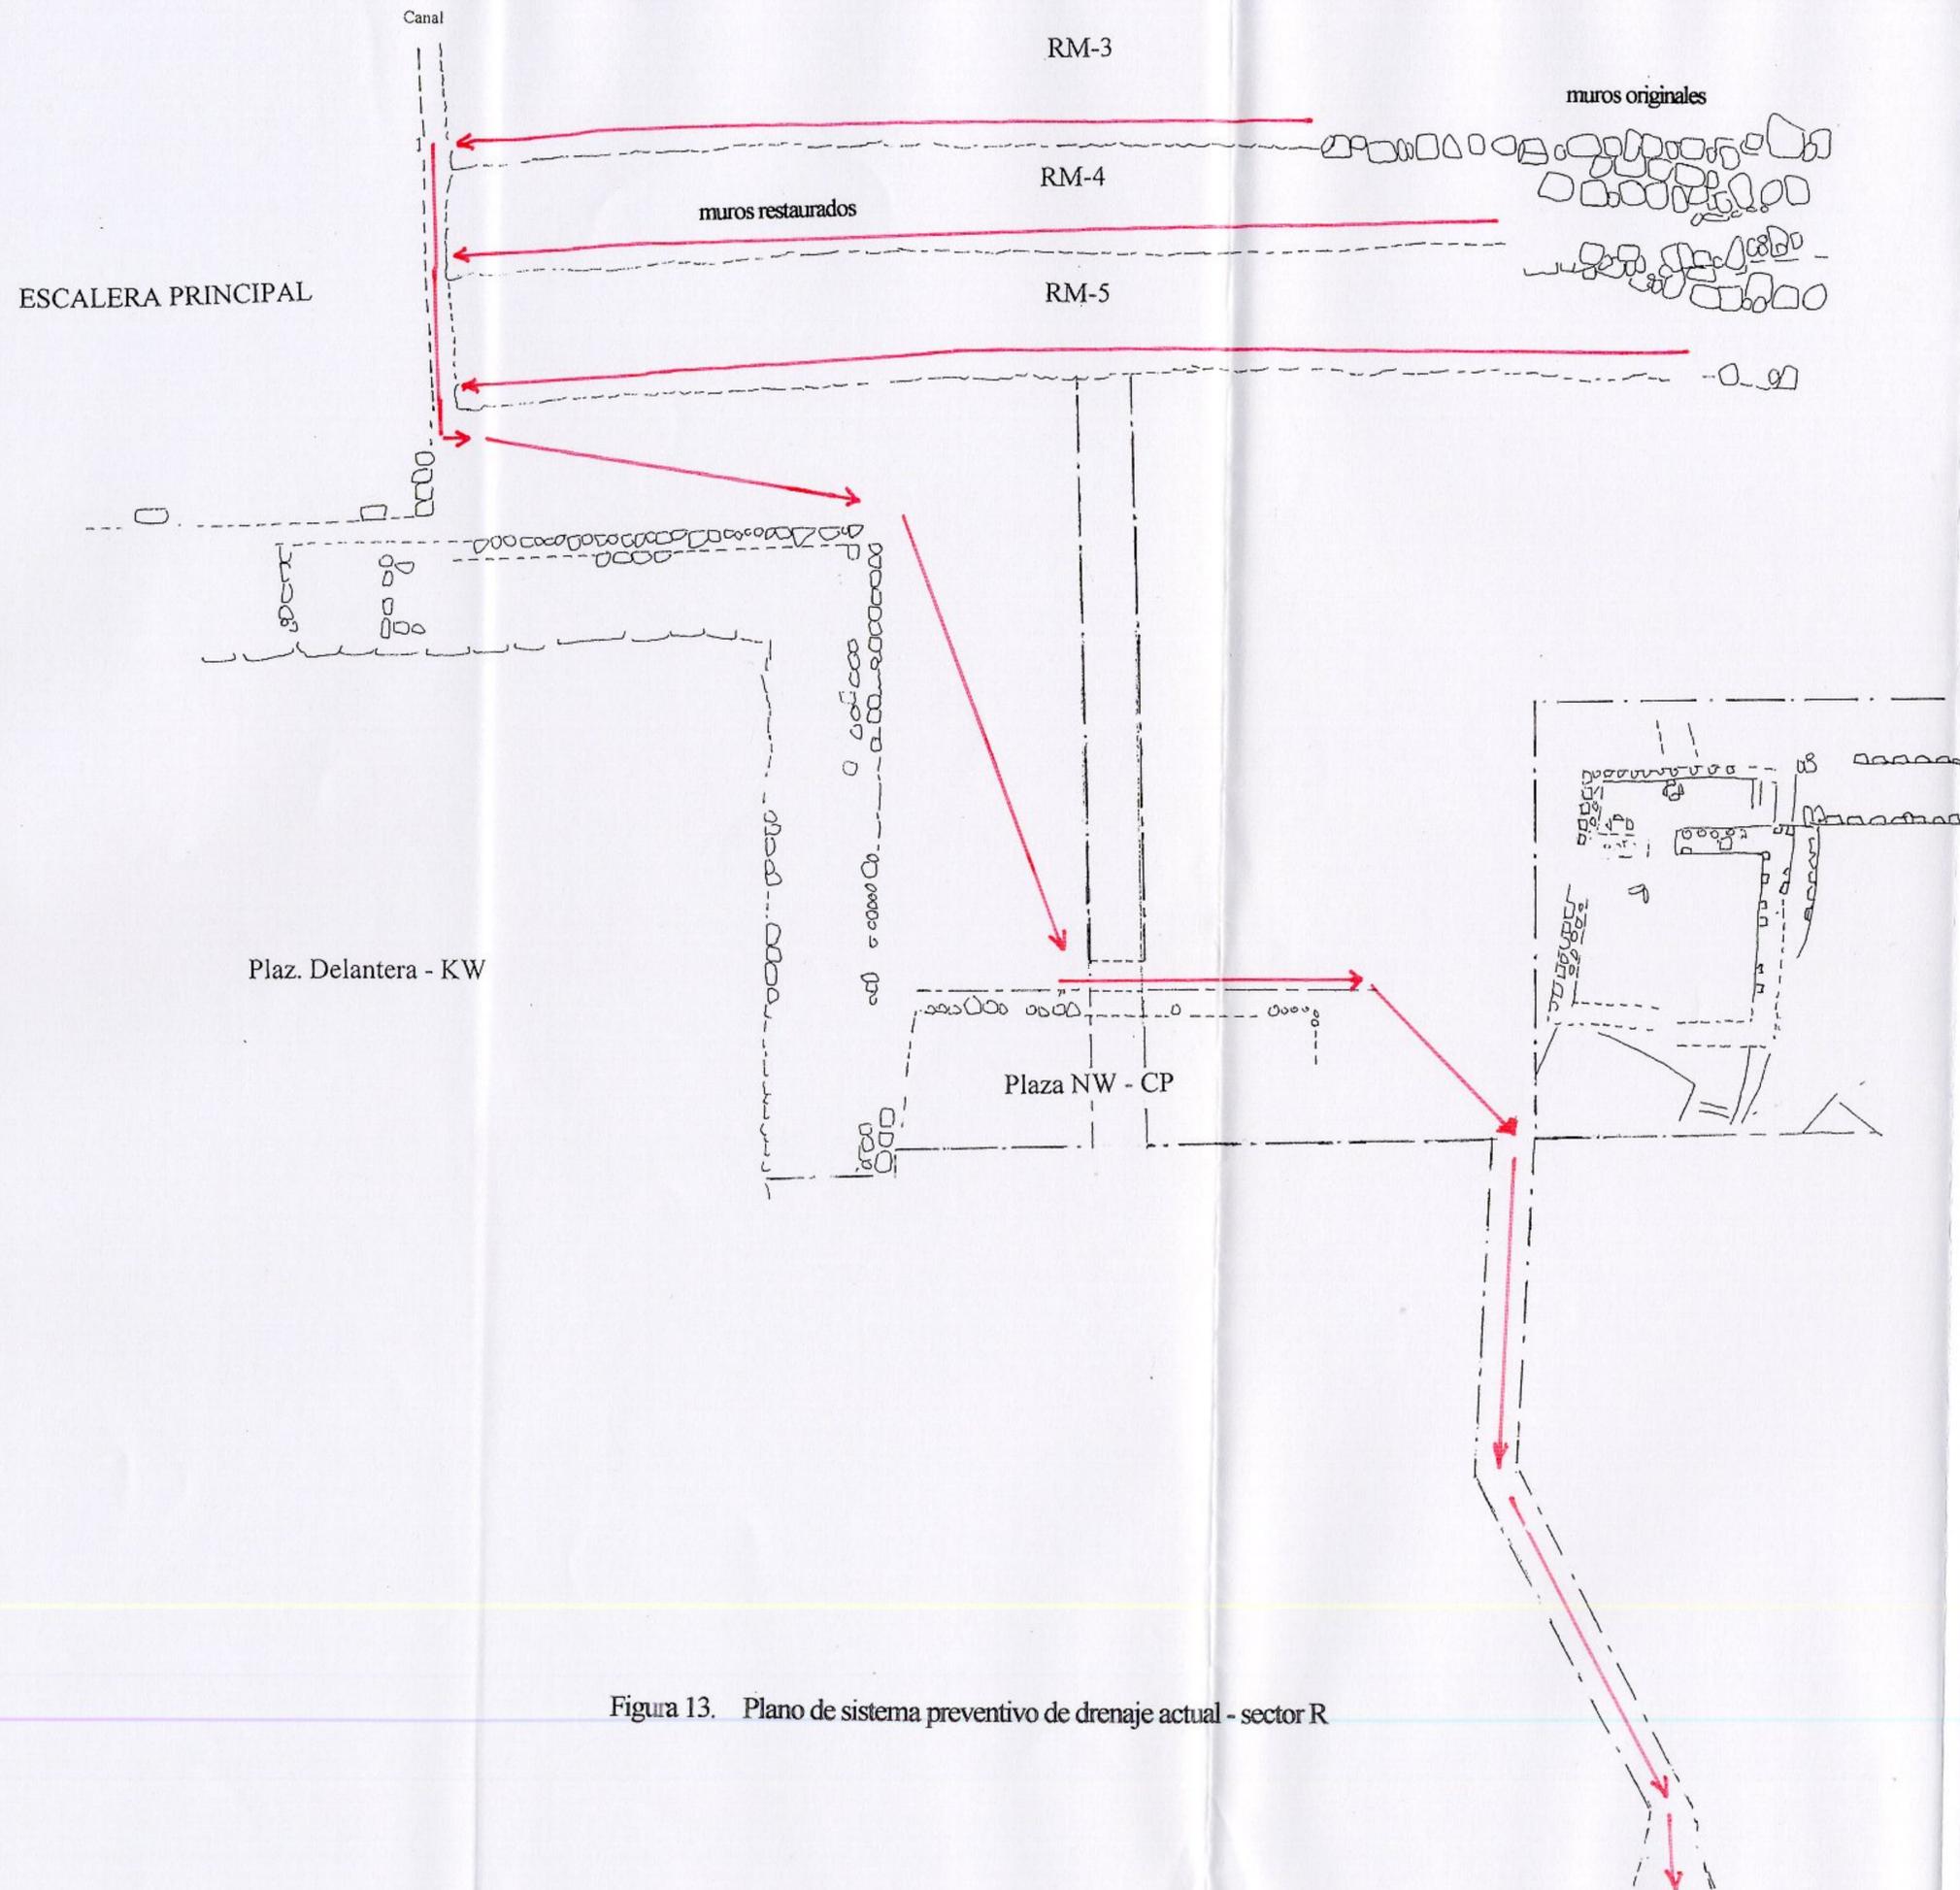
Plano de sistema preventivo de drenaje actual - sector R
